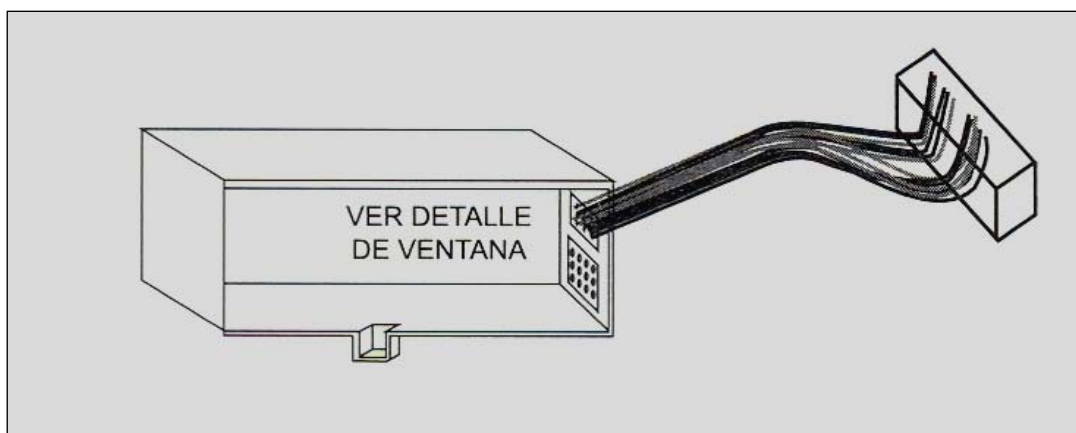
Detalle de Conexión de Pozos Tipo “L” a C.D. Sencilla.
